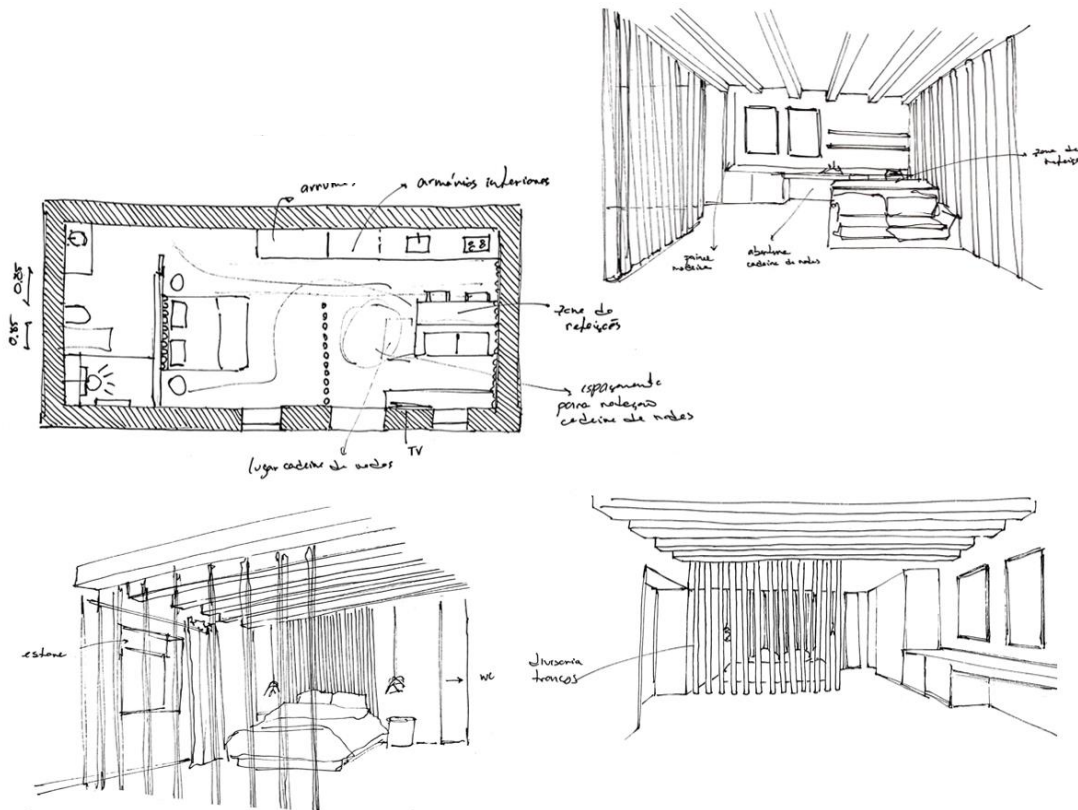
Planta de estudo e Perspetivas, Alojamento Branqueiro.
